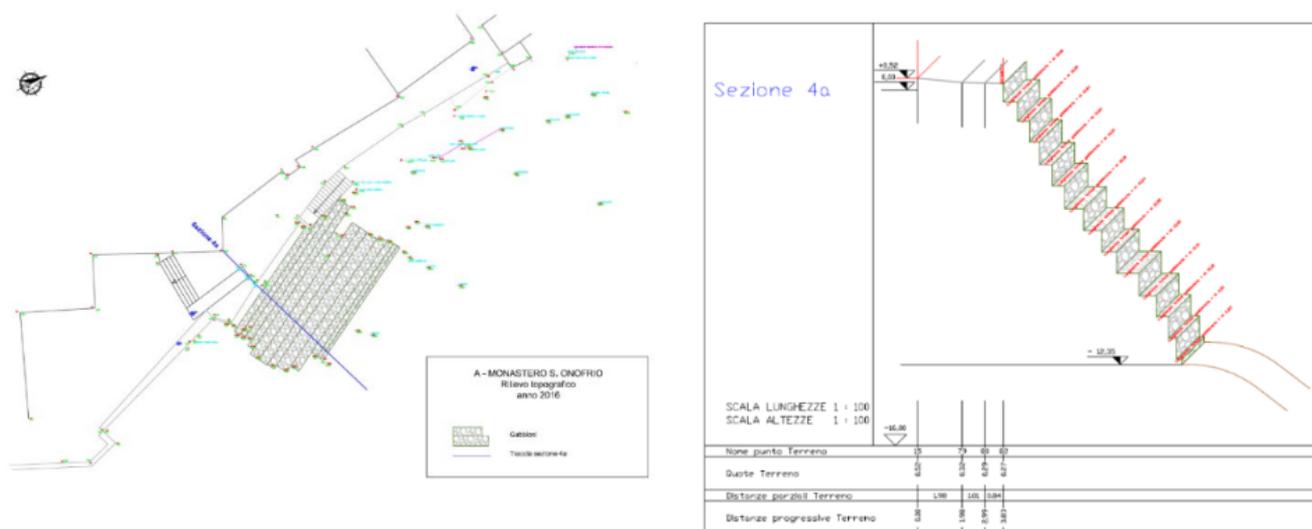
Elaborati grafici di progetto in pianta e sezione della gabbionata esistente.
